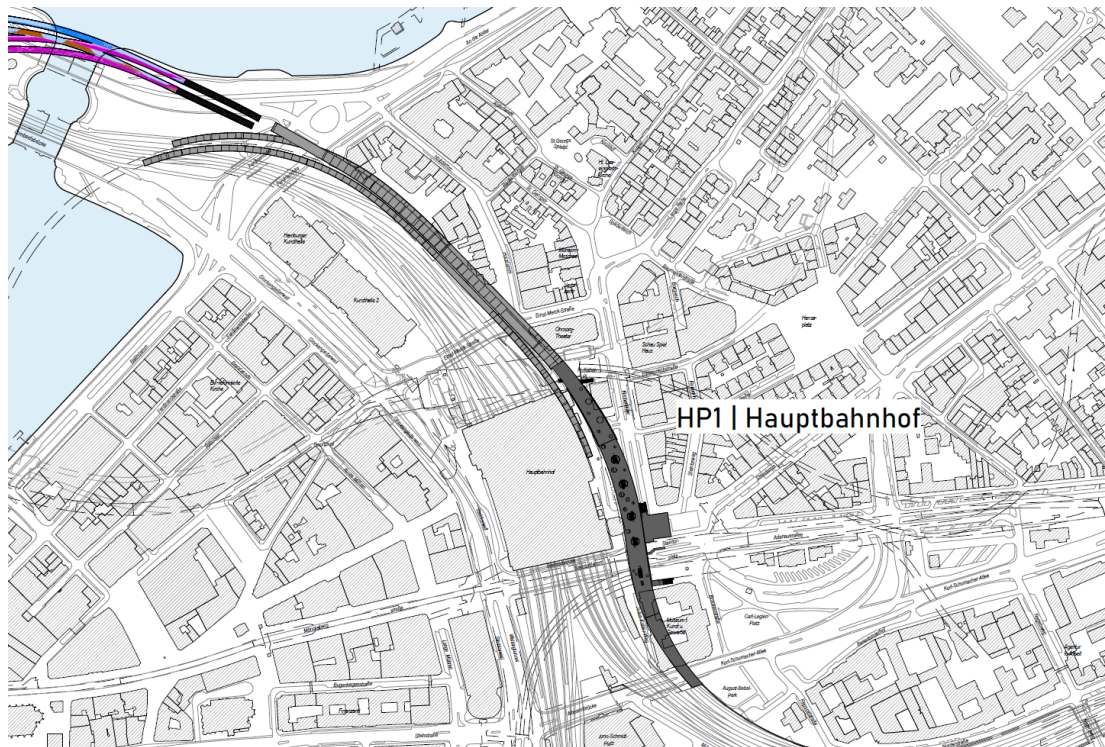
Lageplan Stationsbauwerk HP 1 Hauptbahnhof (Variantenstudie).
